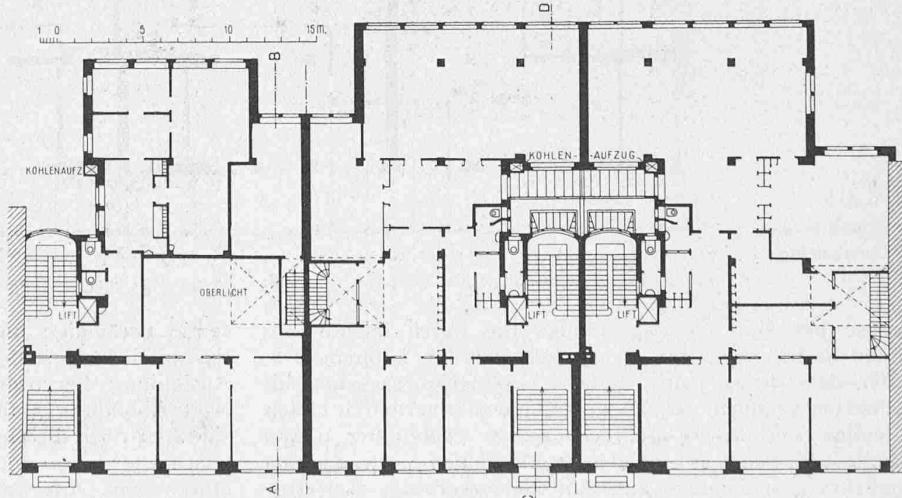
Grundriss vom hochliegenden Erdgeschoss. — Masstab 1:400.
